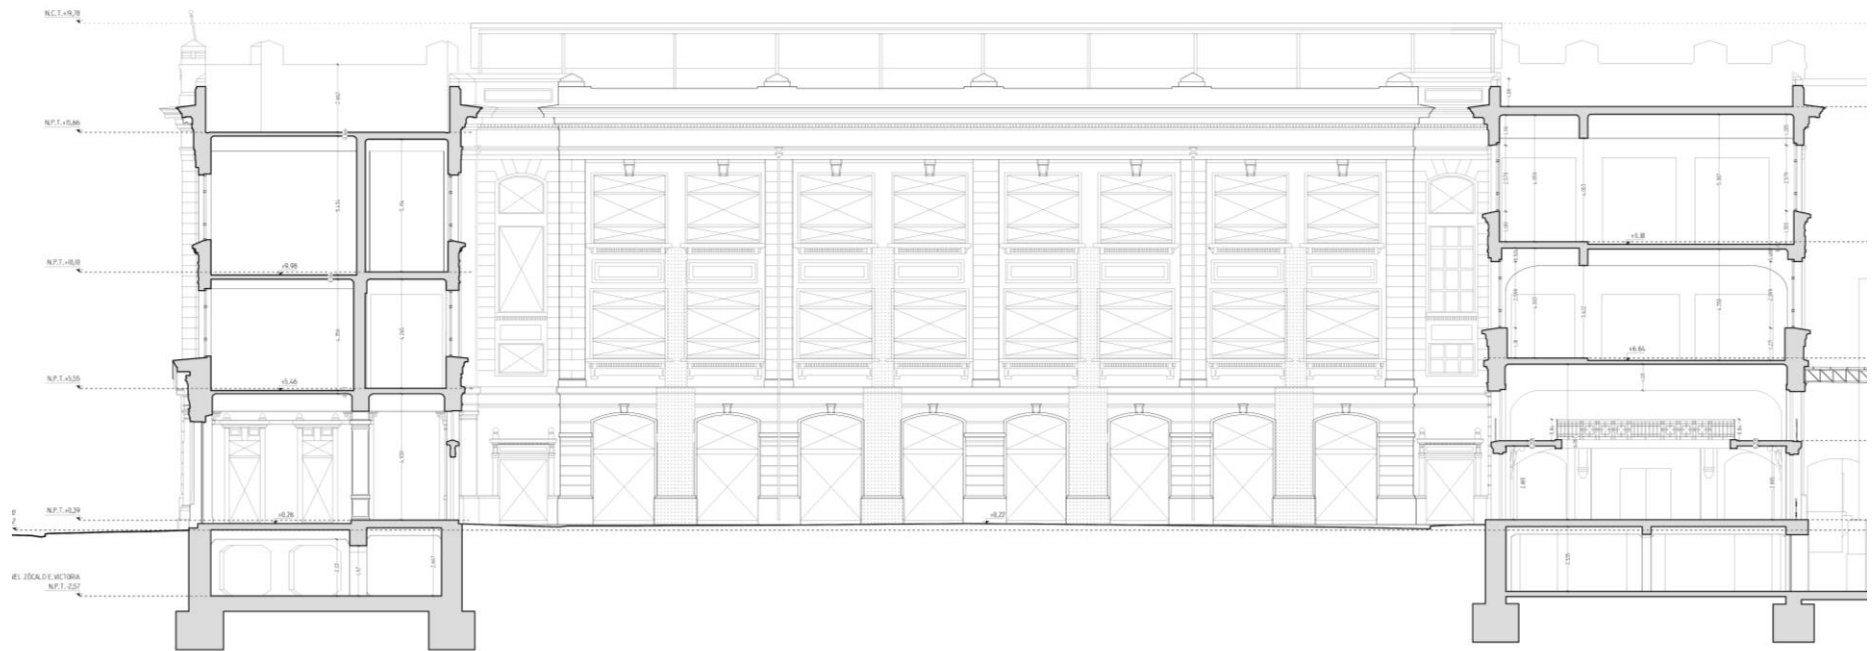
Elevación Fachada Morris Interior previo a la intervención. Fuente: Cyparq.
